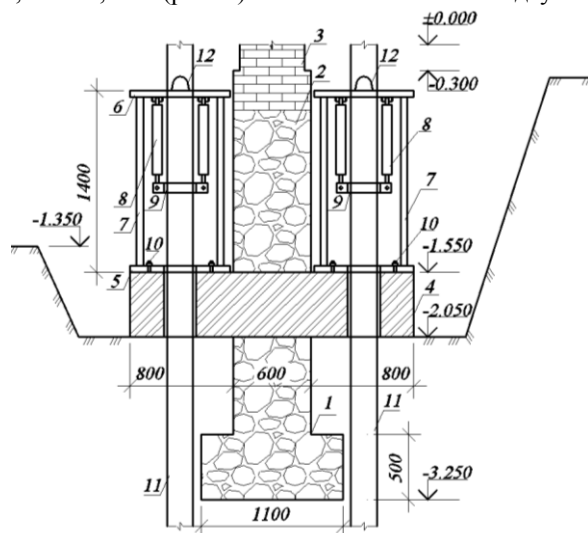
Схема вдавлювання паль: 1 – існуючий фундамент; 2 – гідроізоляція; 3 – цегляна кладка; 4 – розподільча балка; 5 і 6 – нижня та верхня опорні плити; 7 – стояки; 8 – гідроциліндри; 9 – захват для секцій паль; 10 – анкерні болти; 11 – паля; 12 – петля
